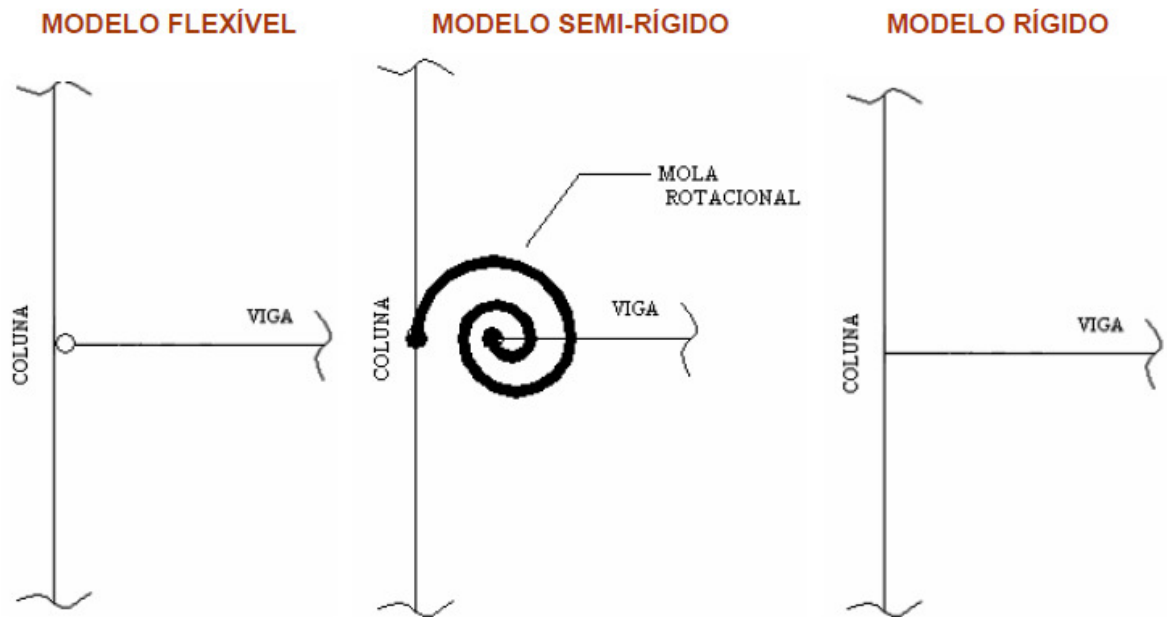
modelagens para ligação viga-coluna (CASTRO, 2006)
